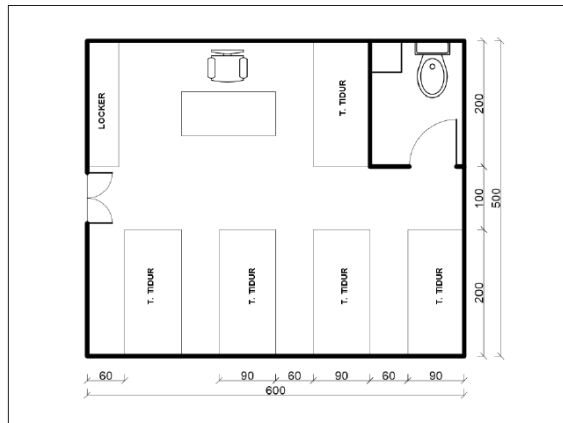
21 Tipikal Denah Ruang Tunggu Umum
